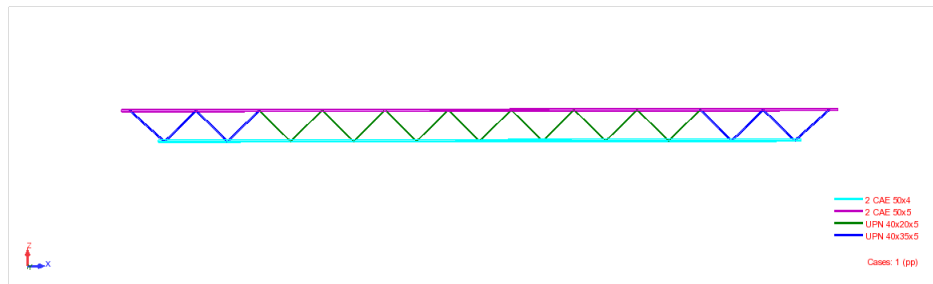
Geometria do modelo de cálculo de uma madre metálica treliçada.
